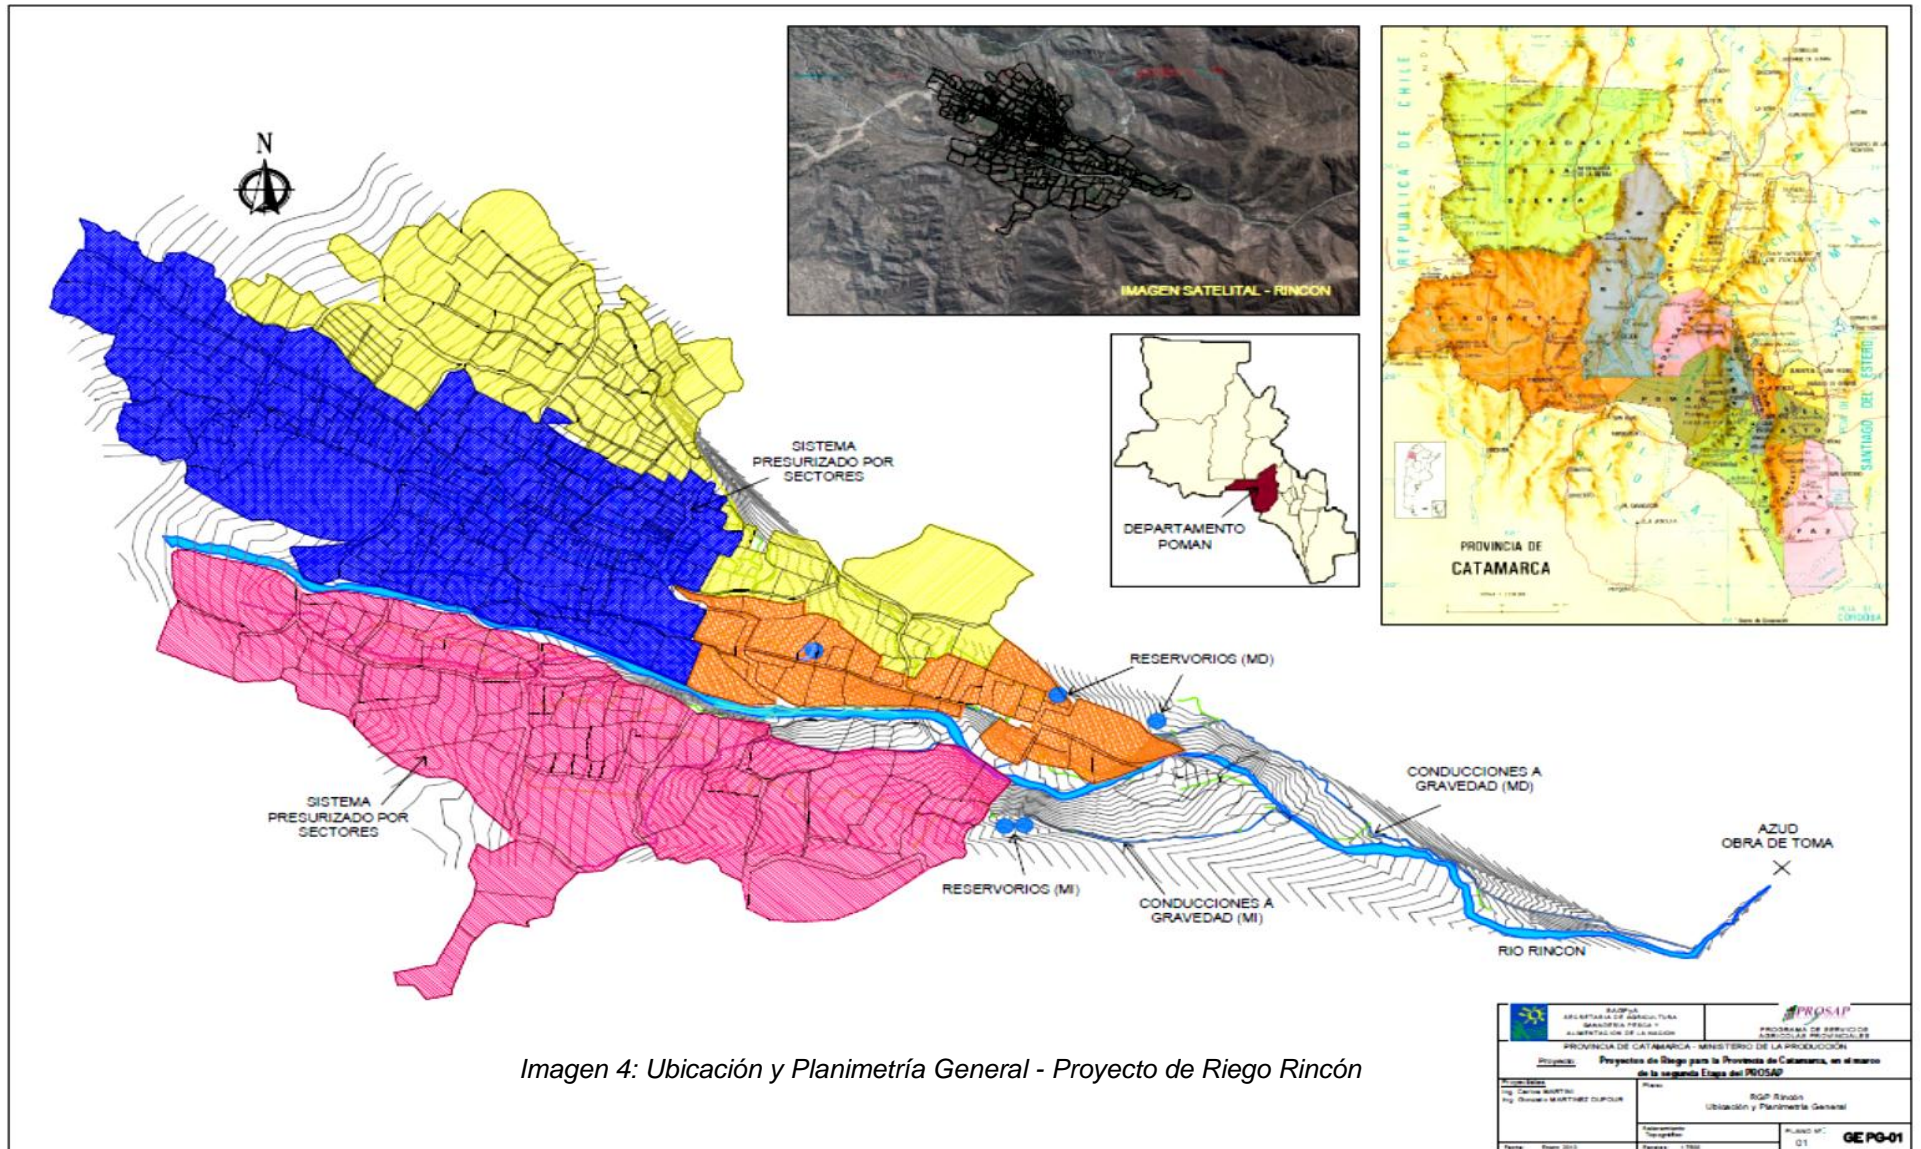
Ubicación y Planimetría General - Proyecto de Riego Rincón
